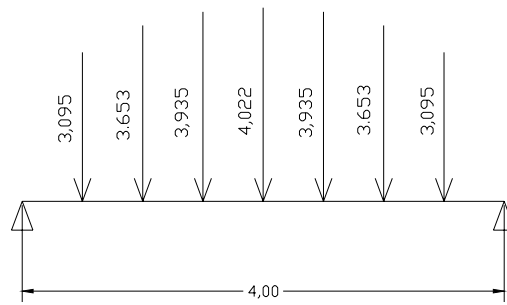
Reações, em kN, na viga VR3 do pavimento PR3
